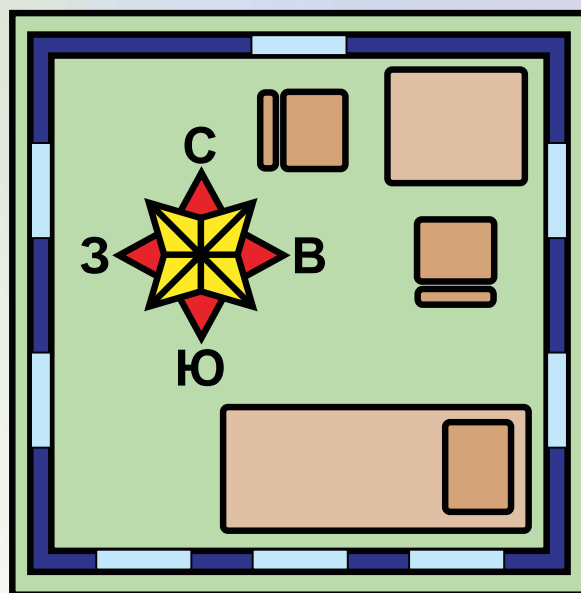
Рекомендуемое соотношение площадей окон по фасадам здания
